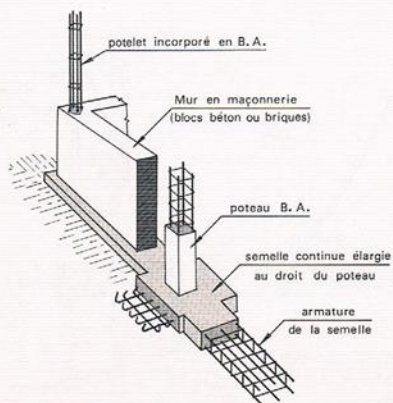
bis - Armature d'une semelle continue sous poteaux B.A.
